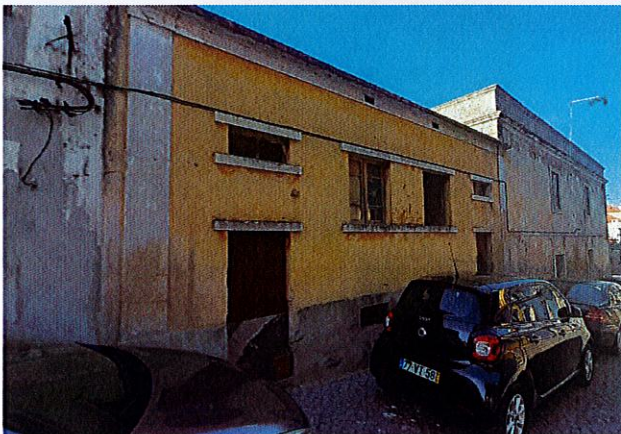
Vista geral sobre a fachada confinante com a Rua Serpa Pinto
